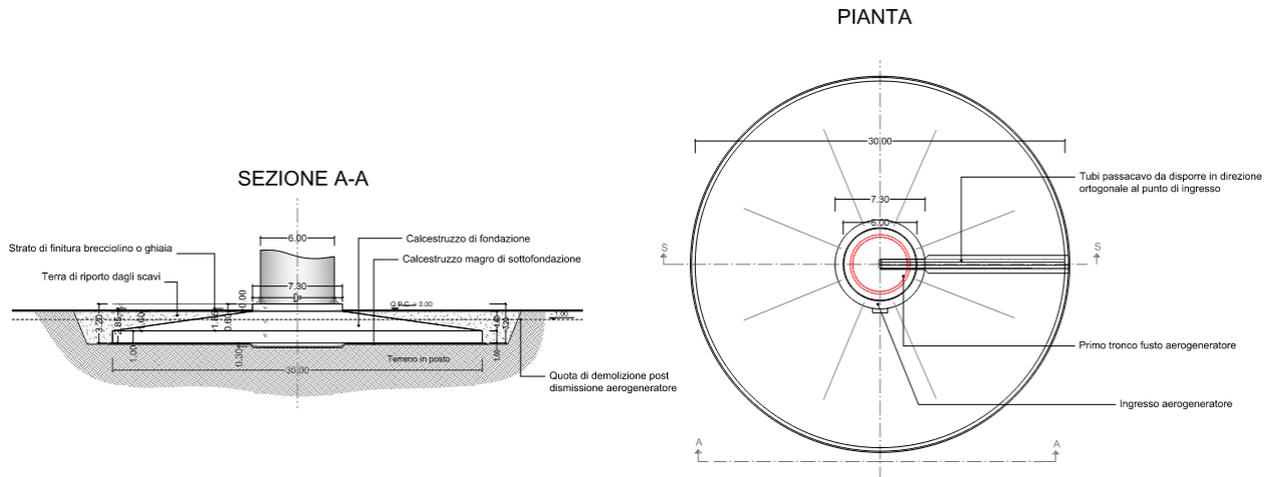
Pianta e vista della fondazione tipo dell'aerogeneratore
